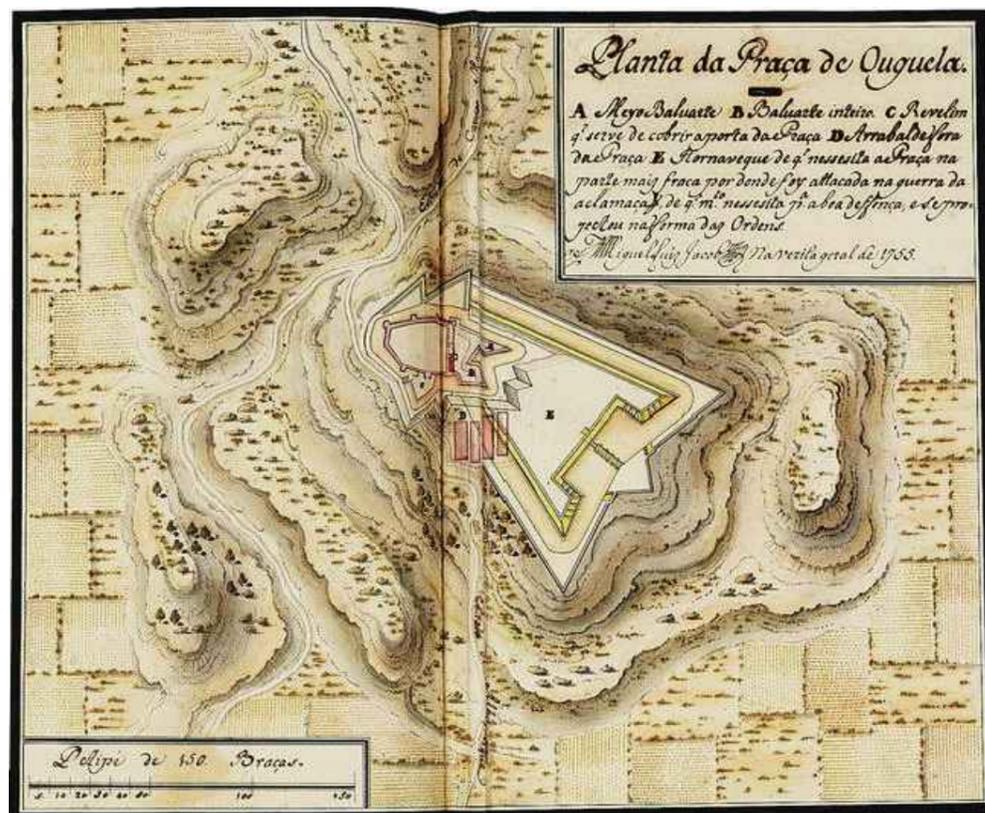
Planta da Praça de Ouguela, Miguel Luiz Jacob, coleção de plantas de praças do Alentejo, 1755
